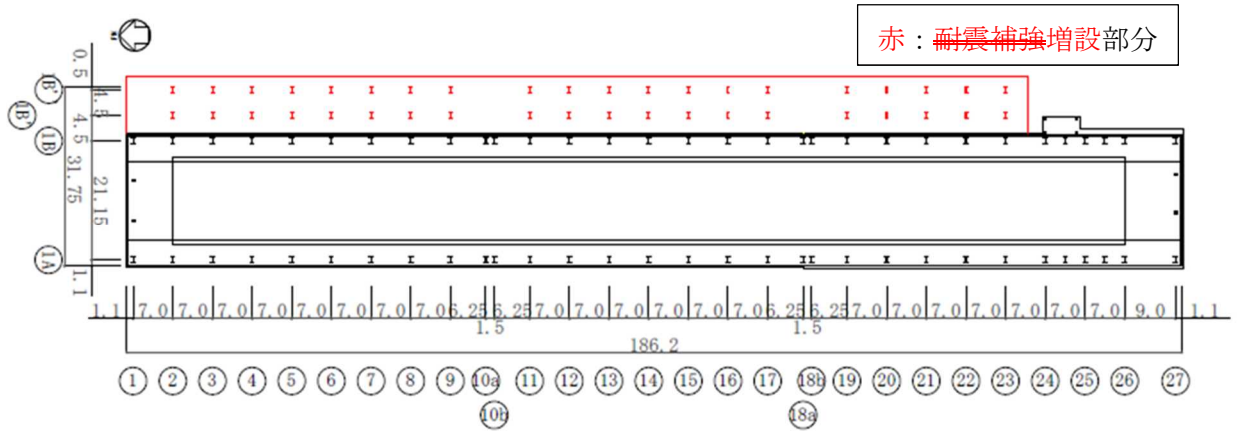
(12) 1階平面図 (G. L. +0.635) (単位 : m)
